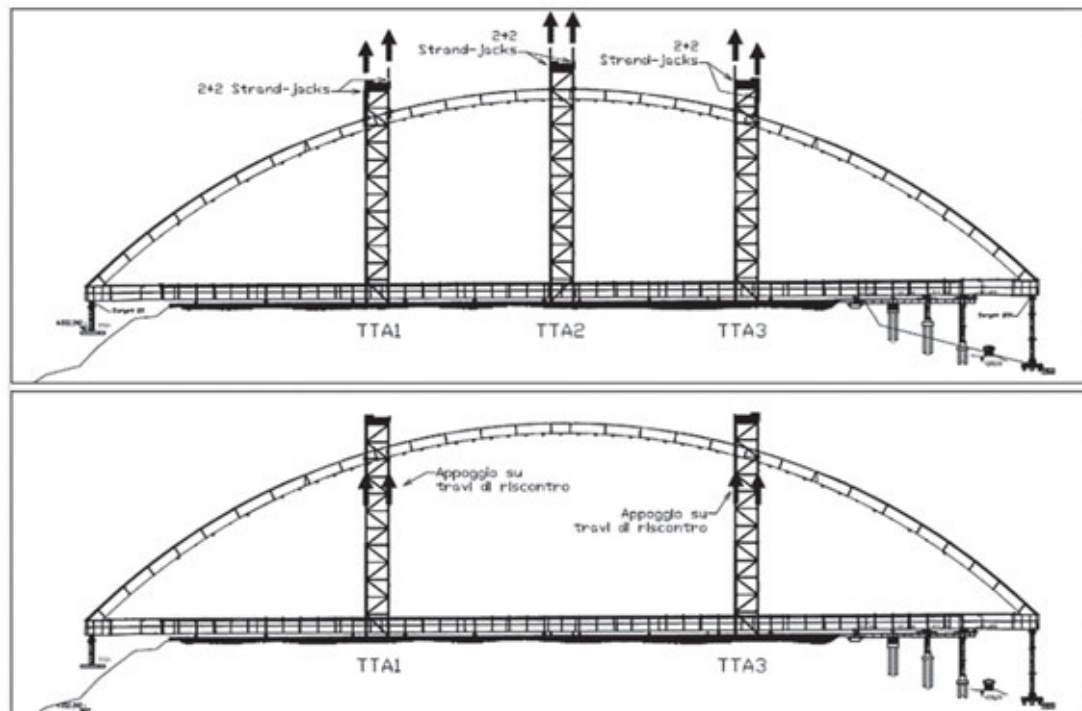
Passaggio del carico da tre torri provvisorie a due e da strand-jacks superiori a traverse di piano | Load transfer from three temporary towers to two and from upper strand-jacks to floor crossbeams
